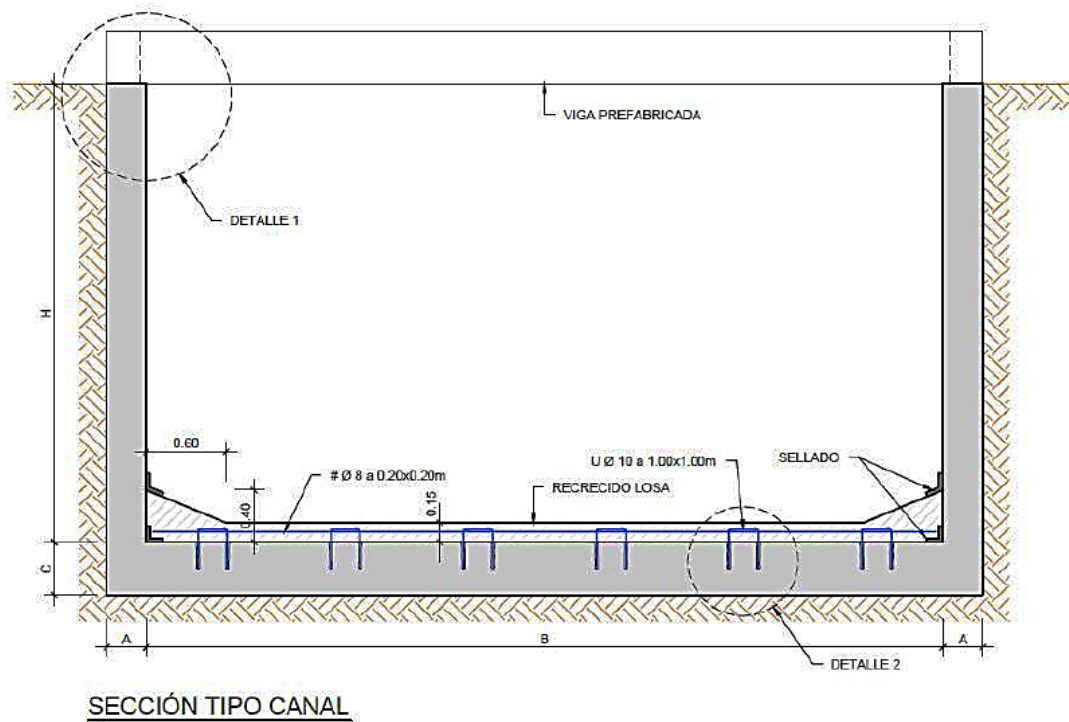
Sección tipo reparación estructural. Canal Calzas Anchas. Utrera (Sevilla). [90]
